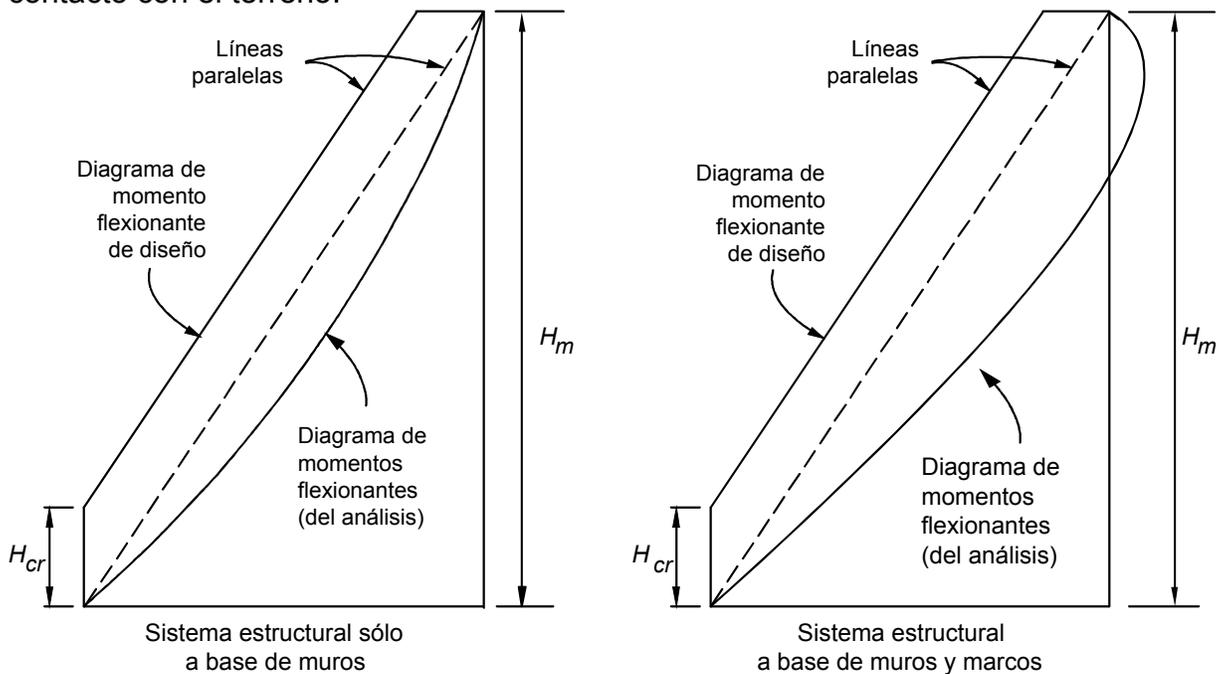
Diagrama de momento flexionante de diseño para muro.
